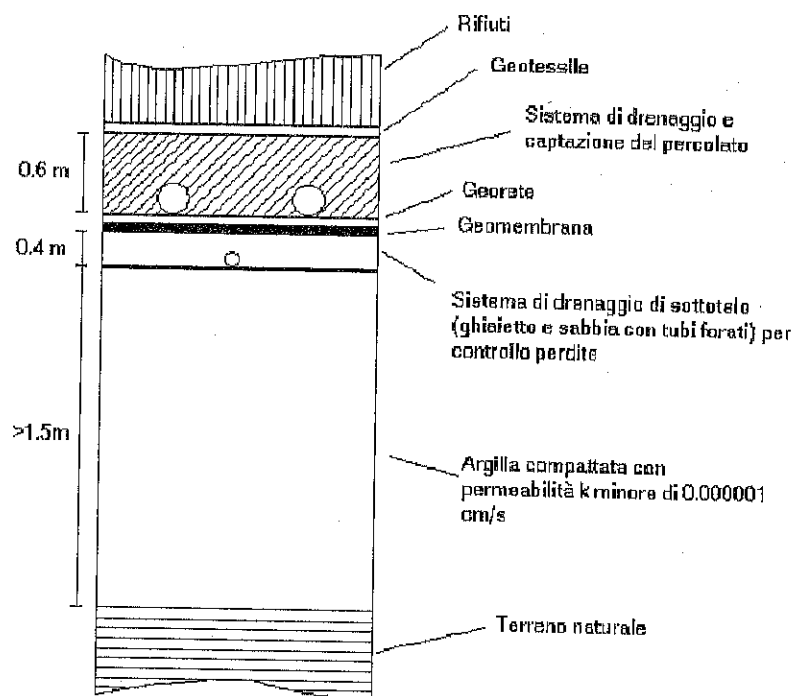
Schema di impermeabilizzazione e drenaggio
